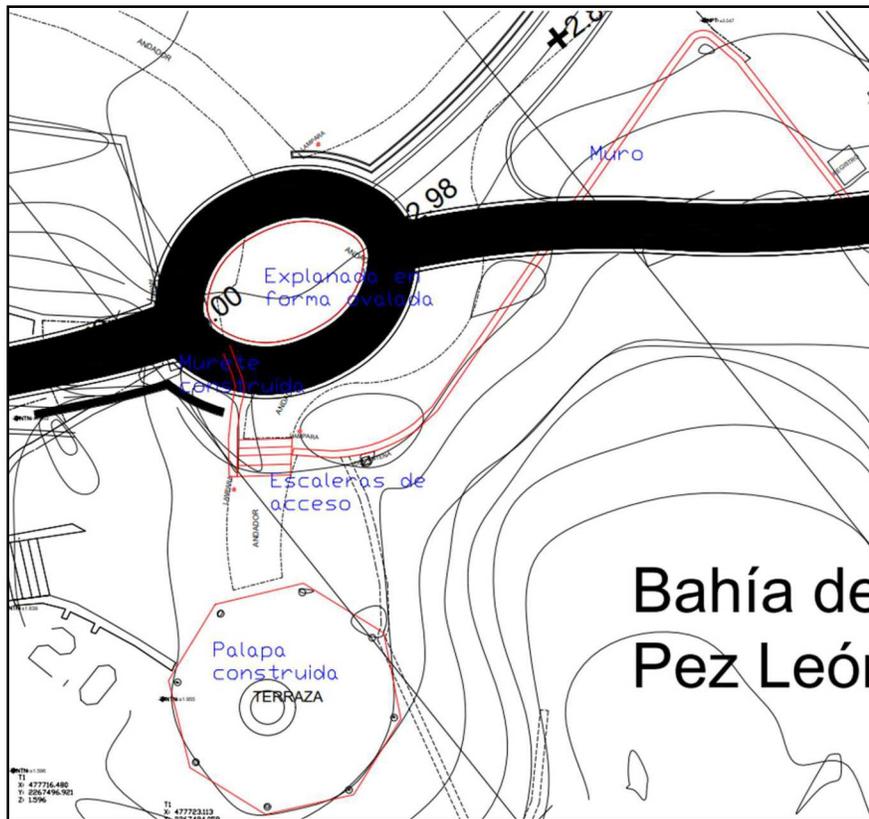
Ubicación de las obras sancionadas y que se pretende su regularización; localizadas entre la Bahía Sargento y la bahía Pez león (señaladas en color rojo). Extracto del Plano de conjunto.
